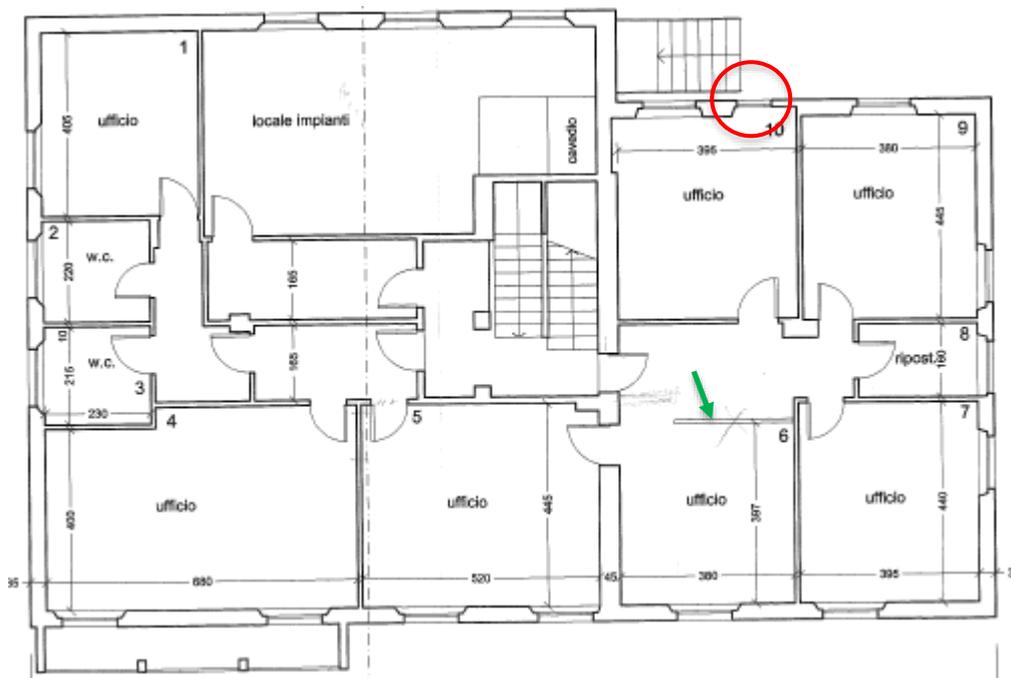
Planimetria dell'u.i. nello stato di progetto della Concessione edilizia n. 96/99
